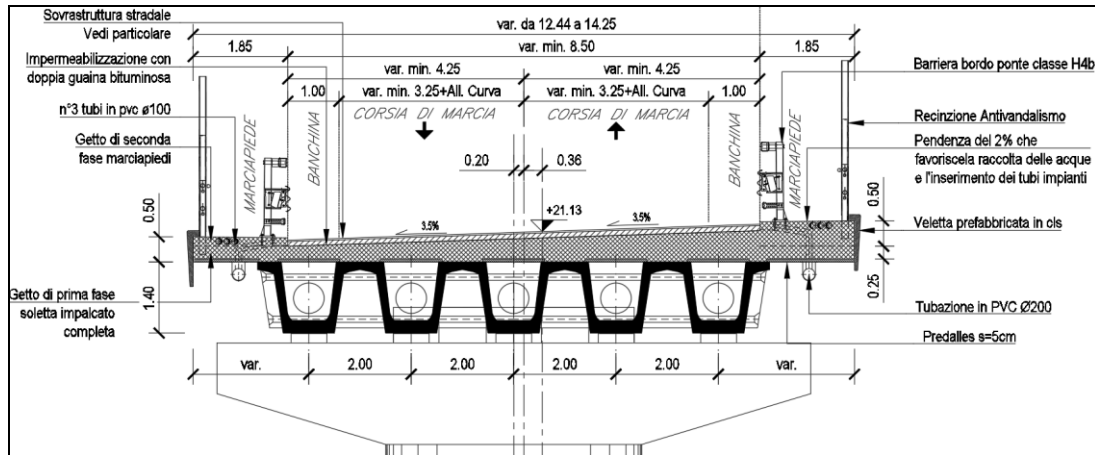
Viadotto IV01 su viabilità NV01: sezioni trasversali e prospetto
